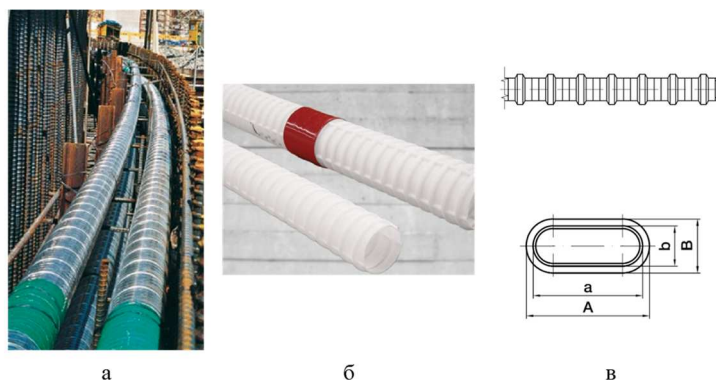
Види каналоутворювачів: а) круглий металевий; б) круглий пластиковий; в) плоский пластиковий
